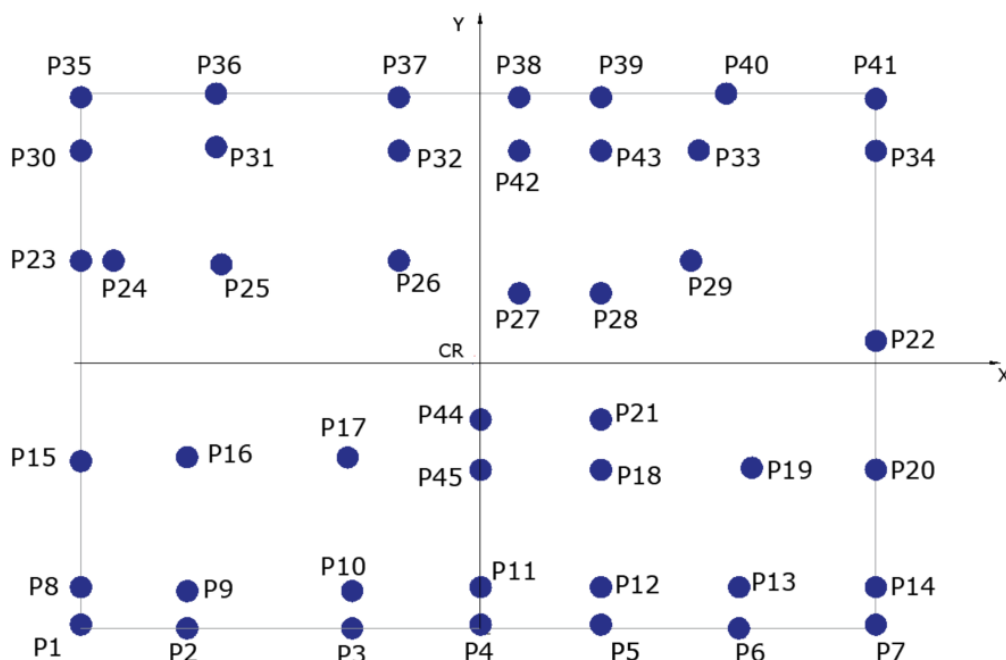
Distribuição dos dispositivos de apoio em planta
